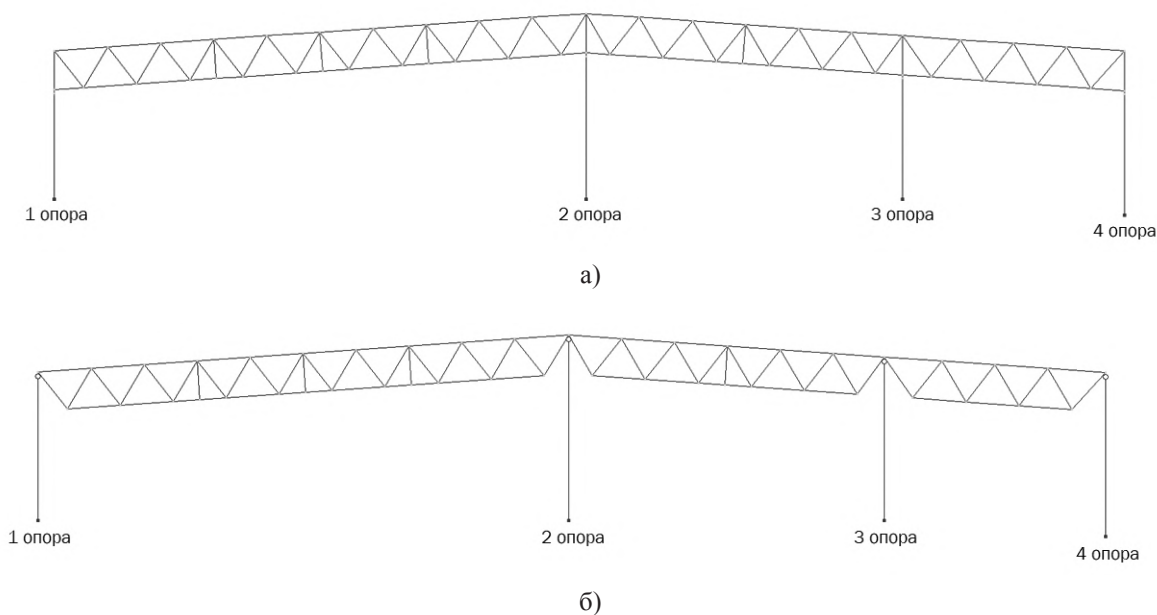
Варианты расчетной схемы поперечной рамы здания:
